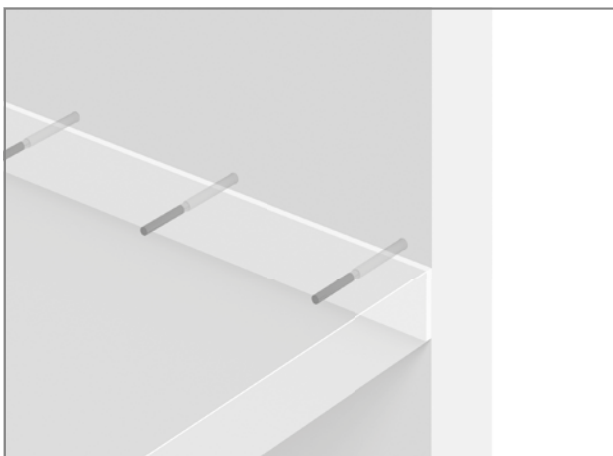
Schöck Dorn type LD : liaison dalle-mur
